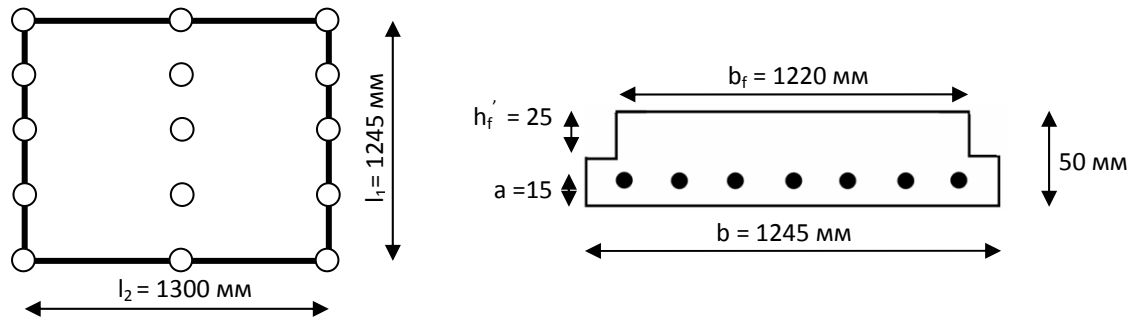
Расчетная схема и расчетное сечение ослабленной полки
